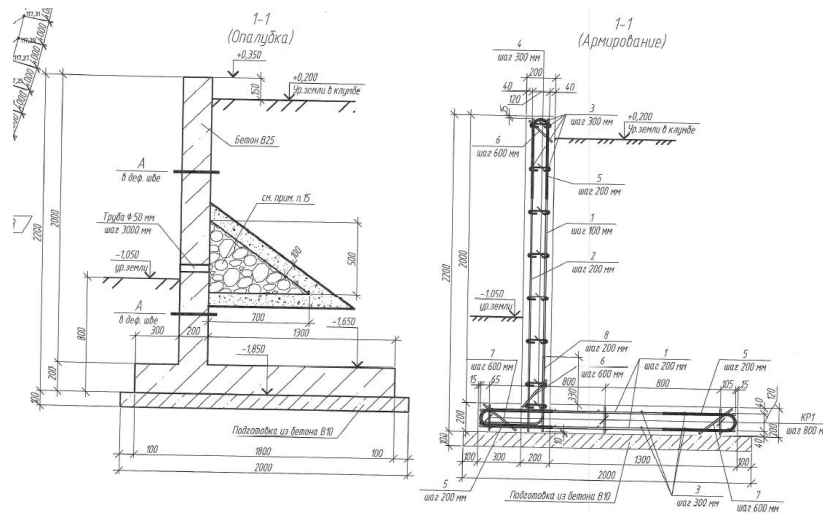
Фундаментная плита с подпорной стенкой под зону с навесом и клумбу
